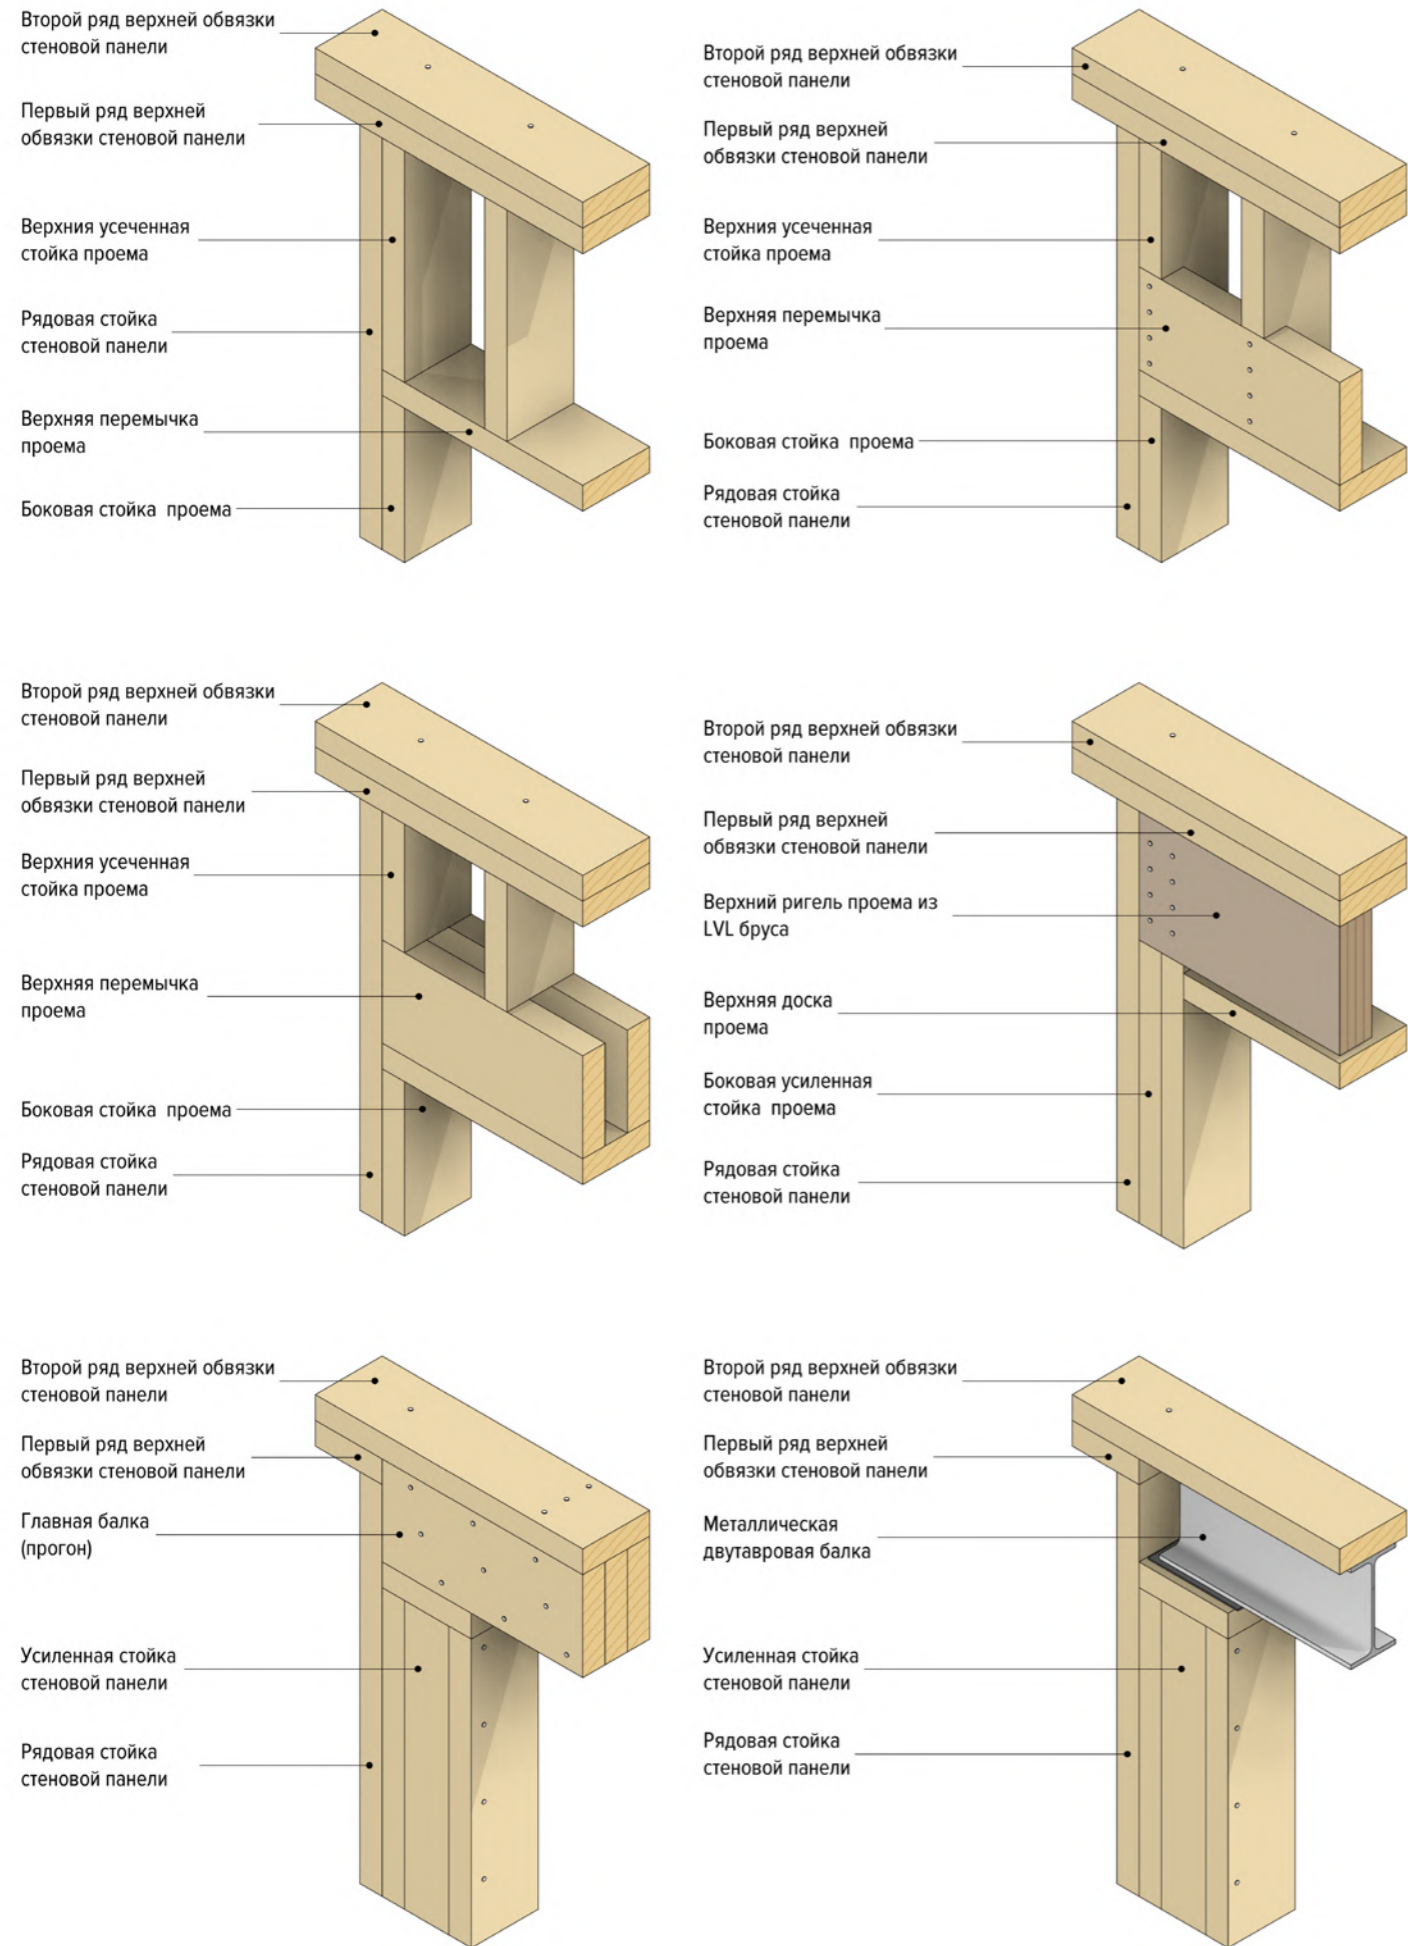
Основные типы перемычек каркаса стеновой панели
